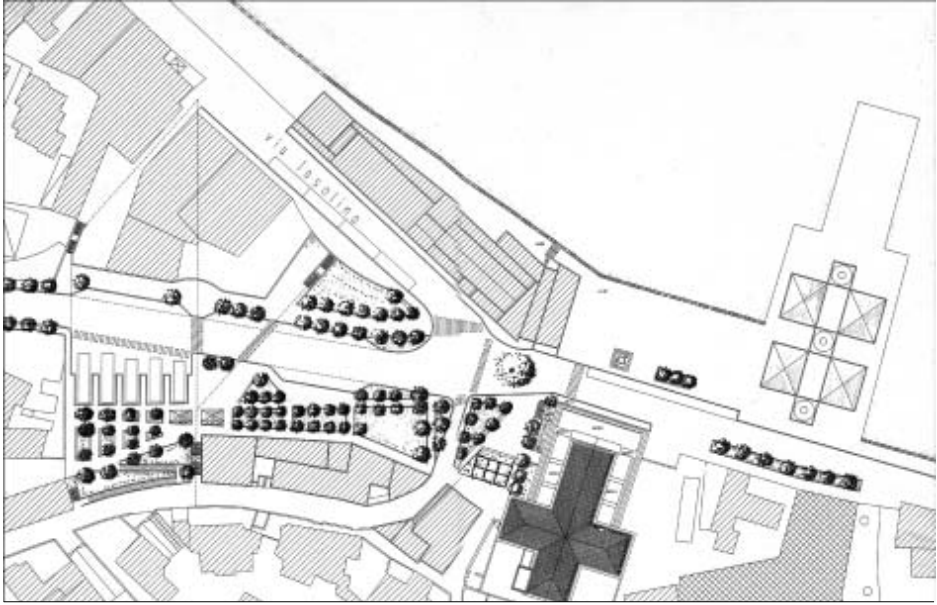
F. Rispoli: planimetria di progetto del Piazzale Trieste
